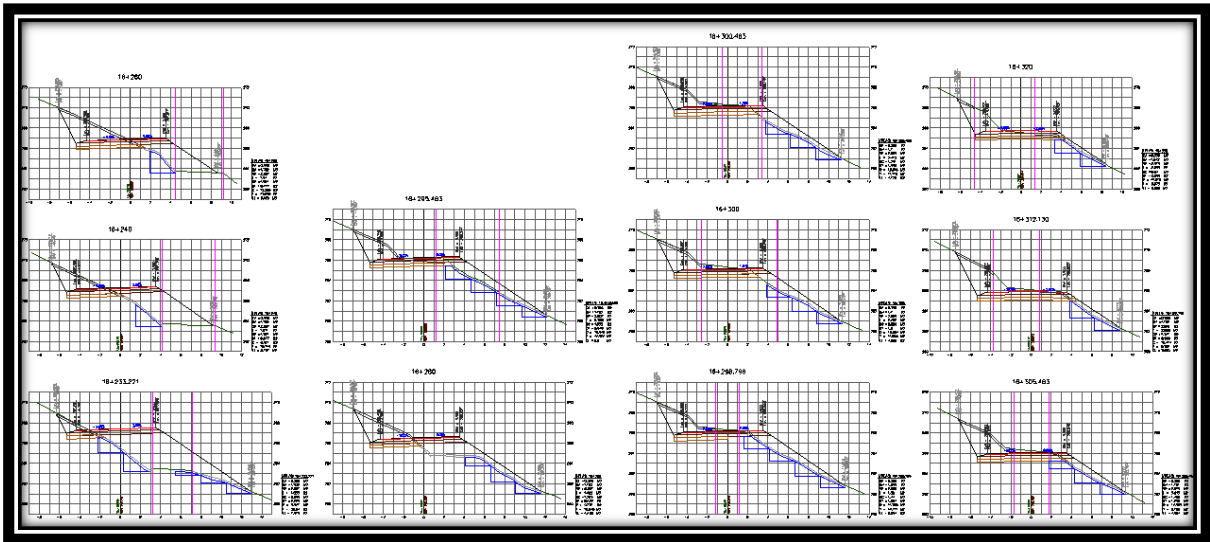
Secciones de construcción del km 16+233.221 al km 16+320.000.
